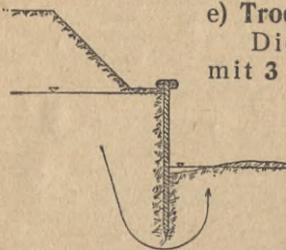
Ausgleich der Wasserspiegel bei dem Auspumpen der Baugrube.
